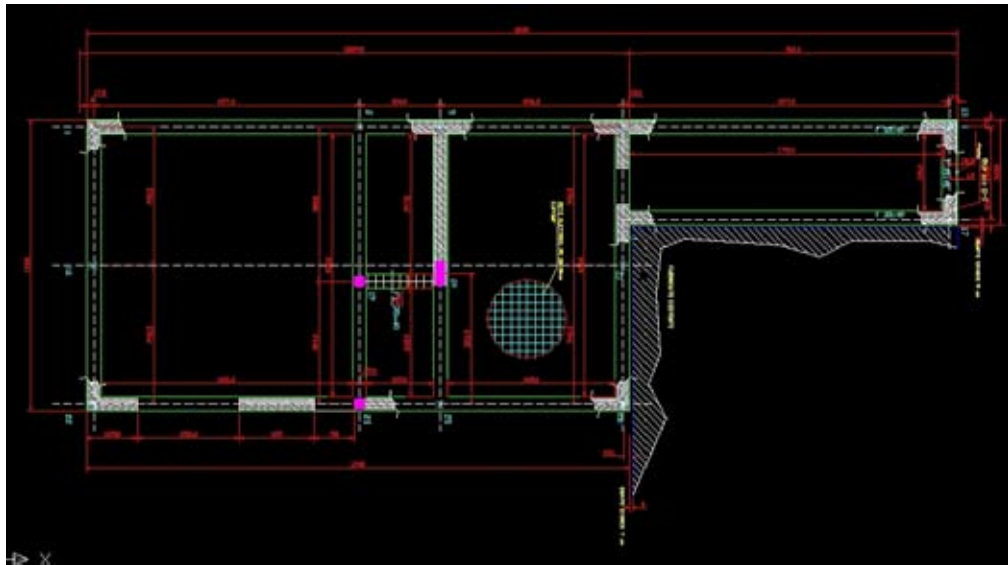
Pianta con la distribuzione della pilastratura e della muratura portante nell'ipotesi "B".
